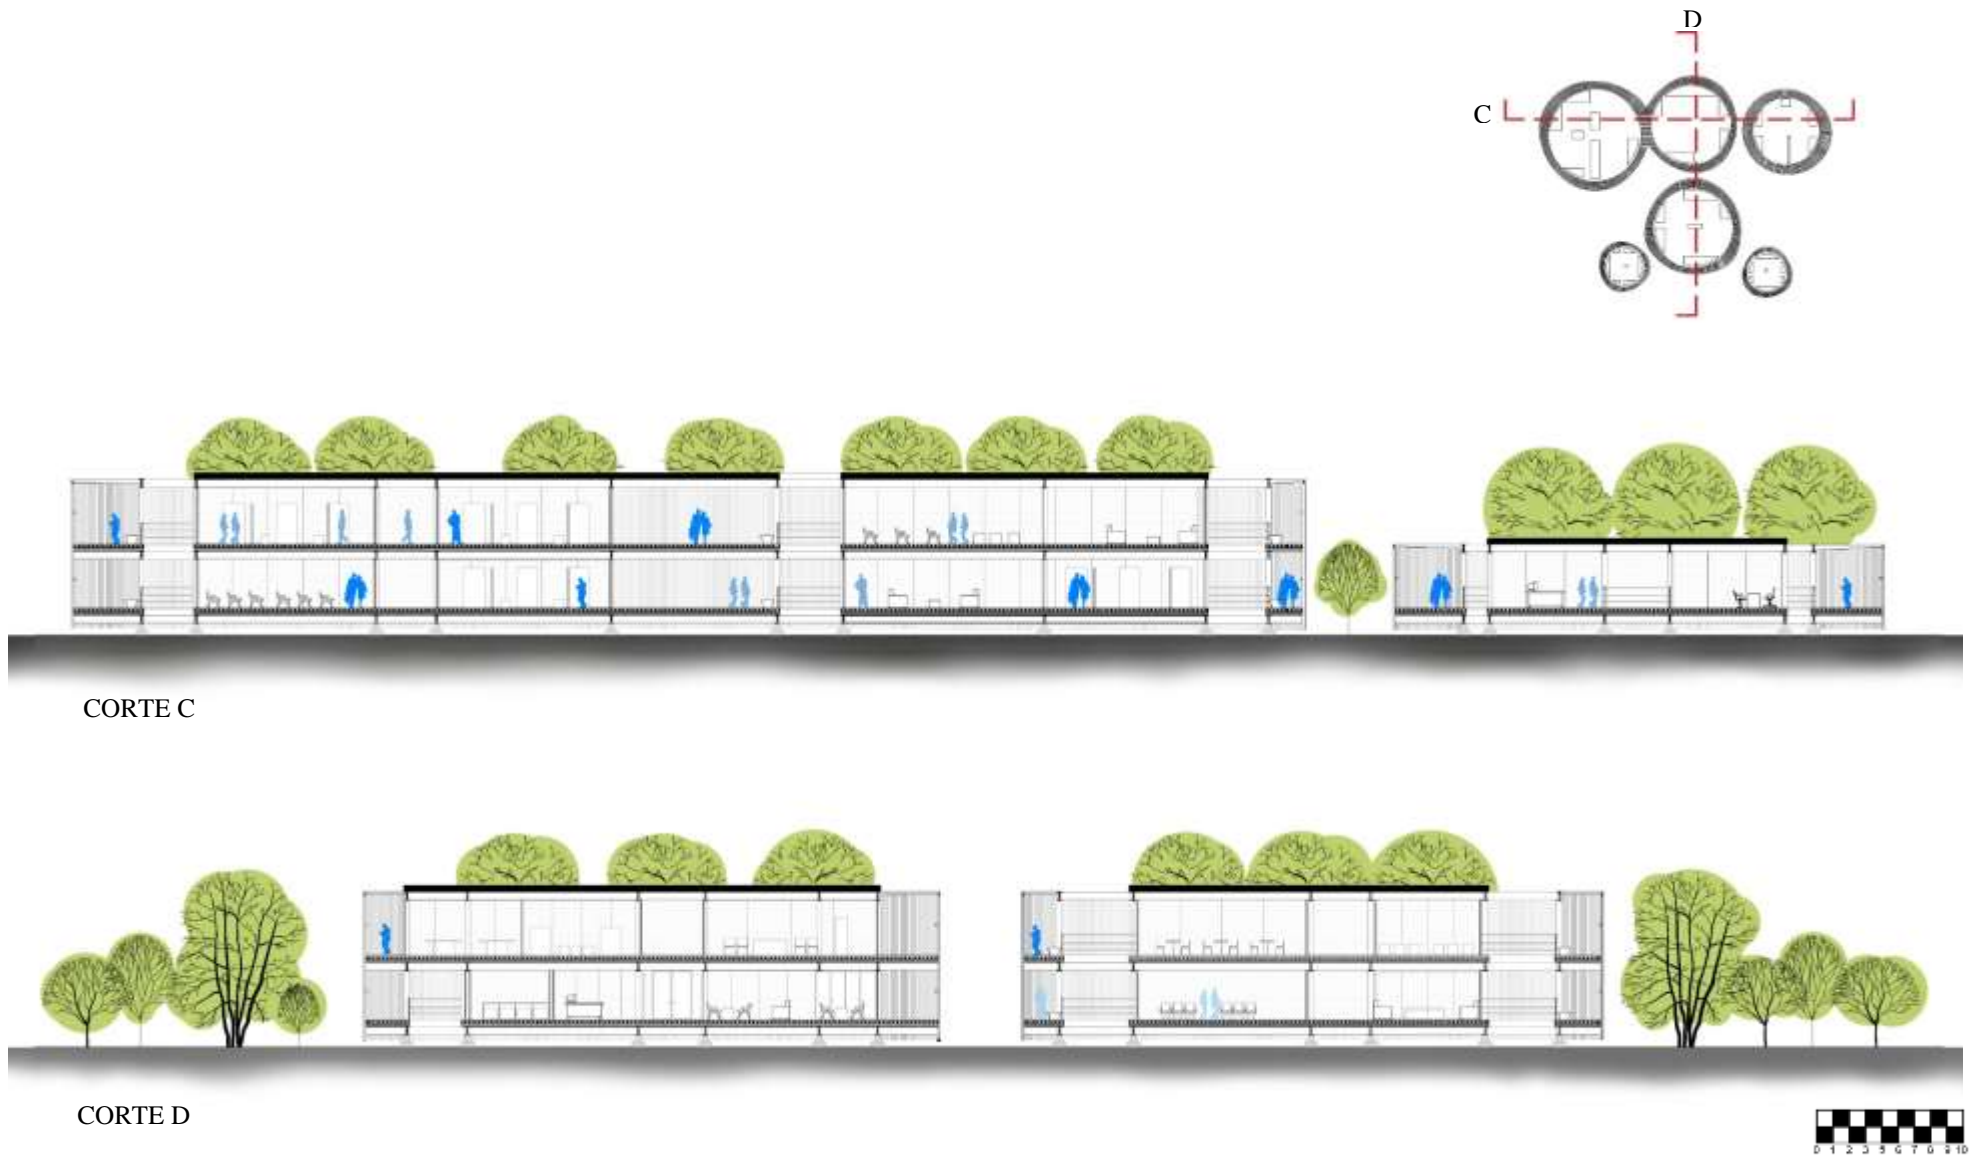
Planos de Cortes C y D. Fuente: Elaboración Propia. Esc. 350
